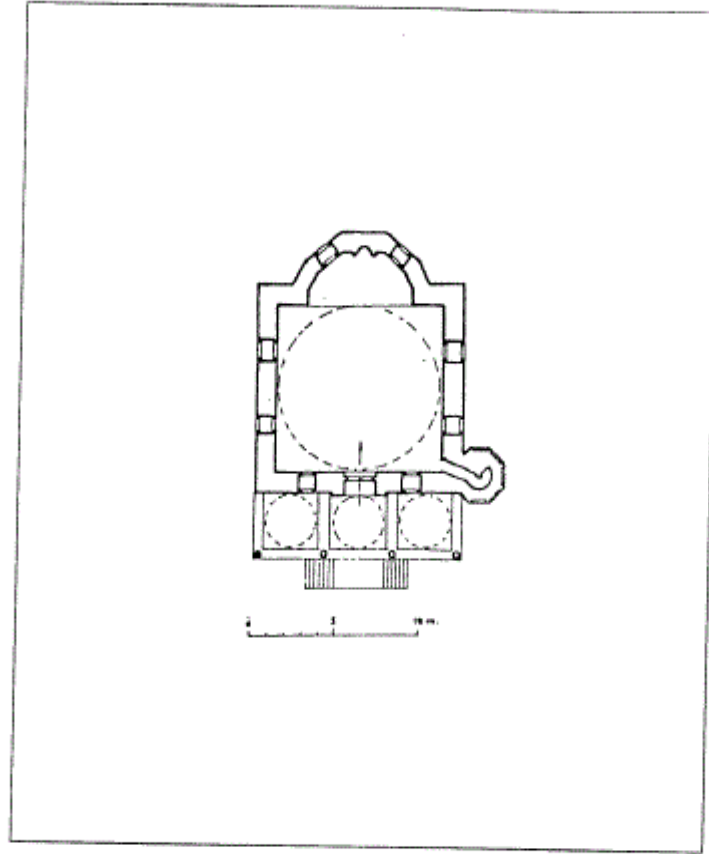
مسقط أفقي لمسجد Hadun في باكوفكا (عن: Pašić).
